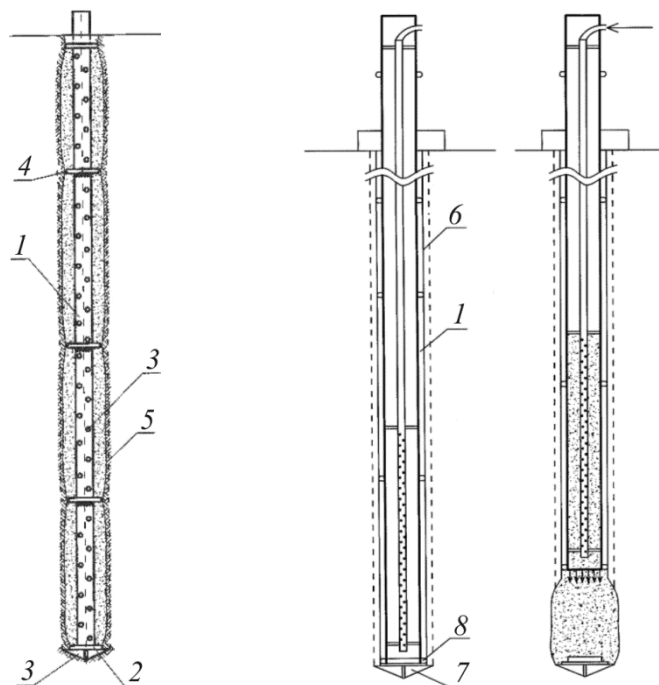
Схемы свай конструкции А.И. Полищука, А.А. Петухова и др.:
